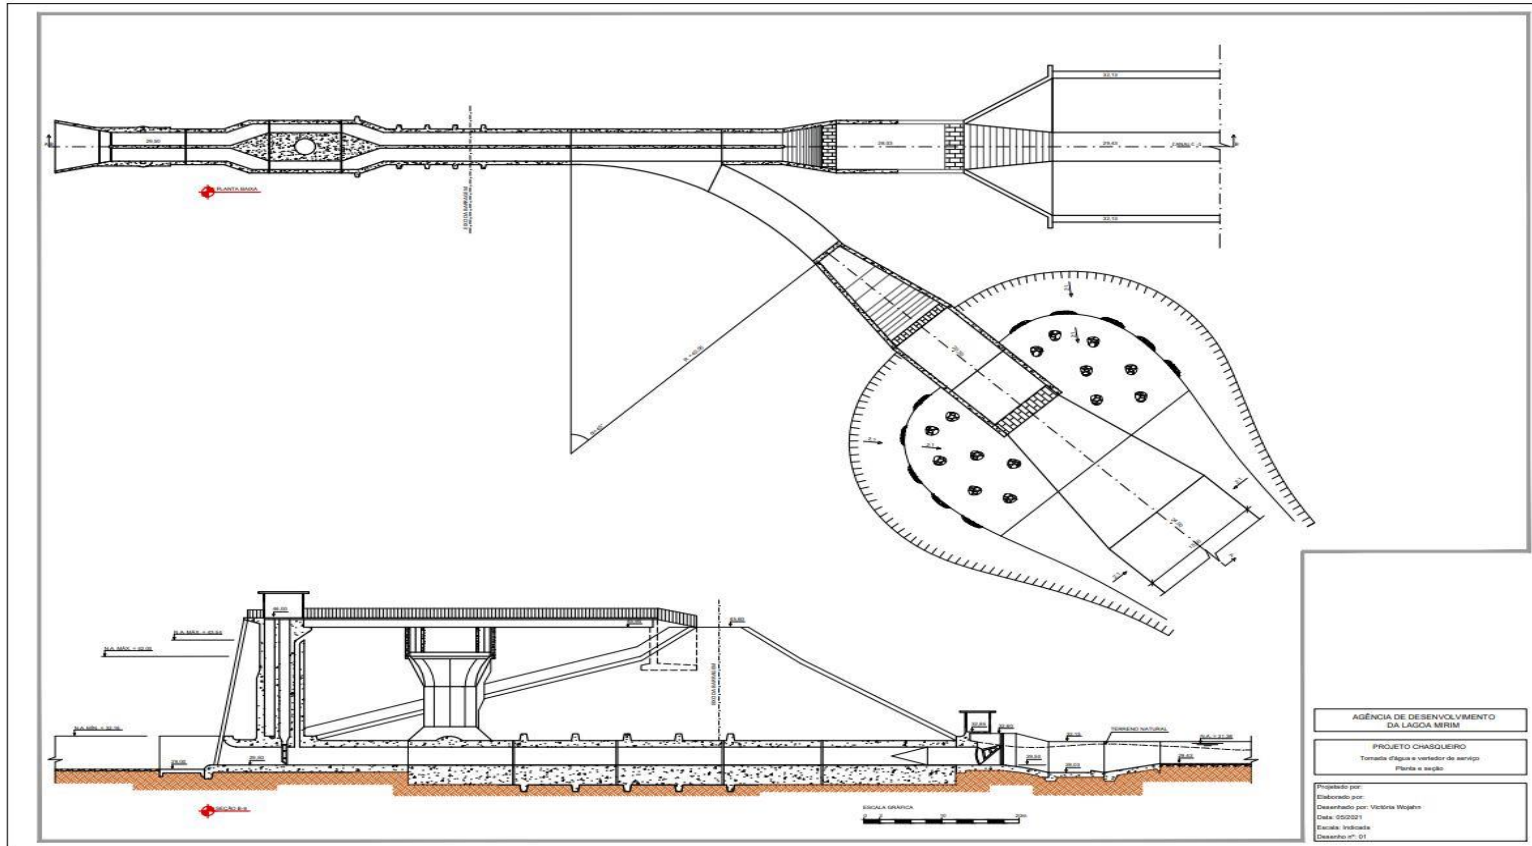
Planta Baixa da seção transversal da tomada d'água.
